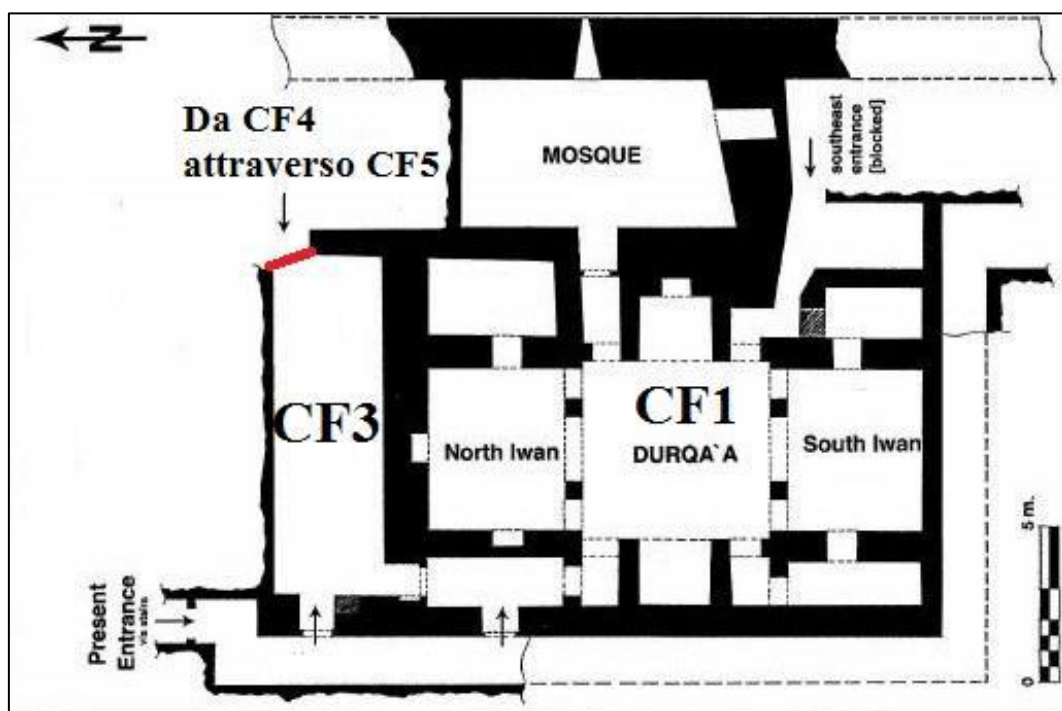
CA1 (tratto da Brown 1989): planimetria generale e indicazione dell'accesso a CF3 attraverso la galleria crociata CF4
